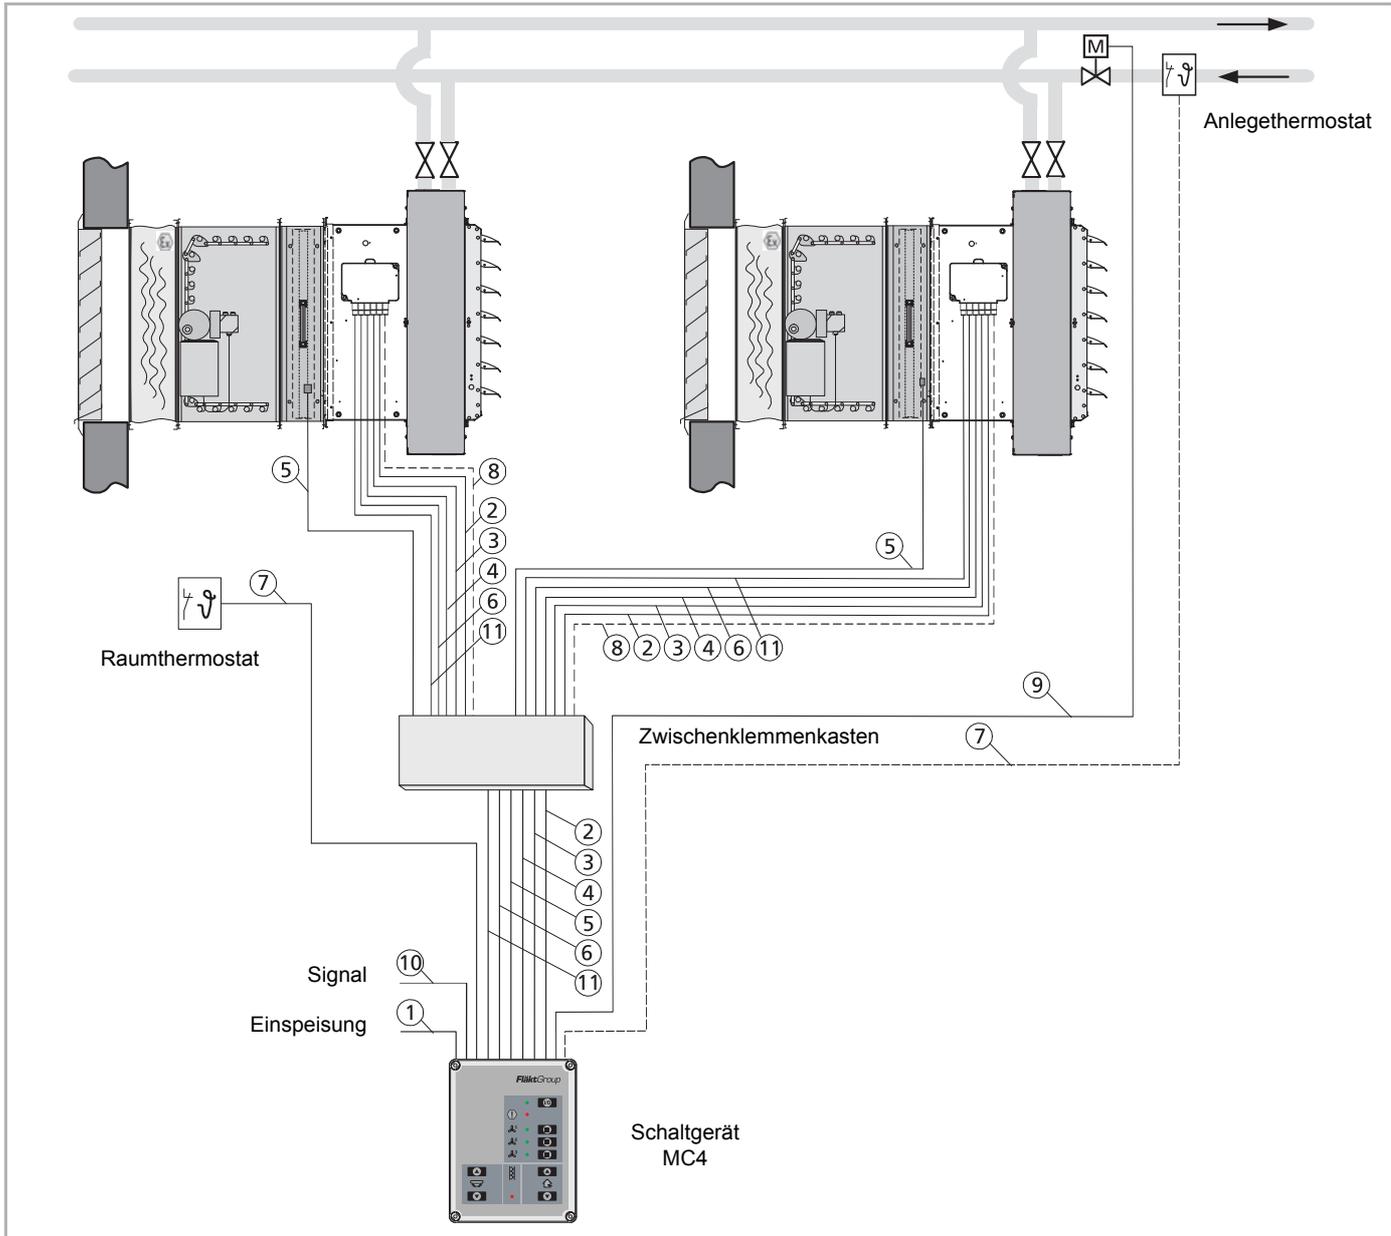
Gerätegruppe bestehend aus Mischluftgeräten MultiMAXX HN mit Schaltgerät MC4
